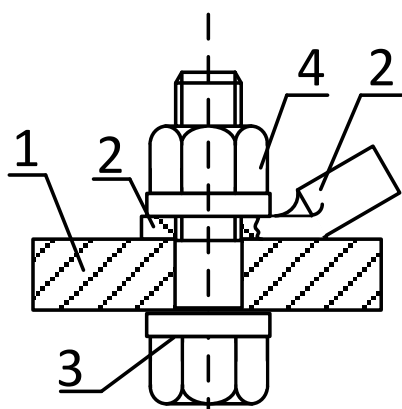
Контактное соединение шин ШЗУП-МУО, ШЗУП-МО и ШЗУП-МДО через отверстие (1 - медная шина; 2 – кабельный наконечник; 3 – болт с зубчатым фланцем; 4 – гайка с зубчатым фланцем).
